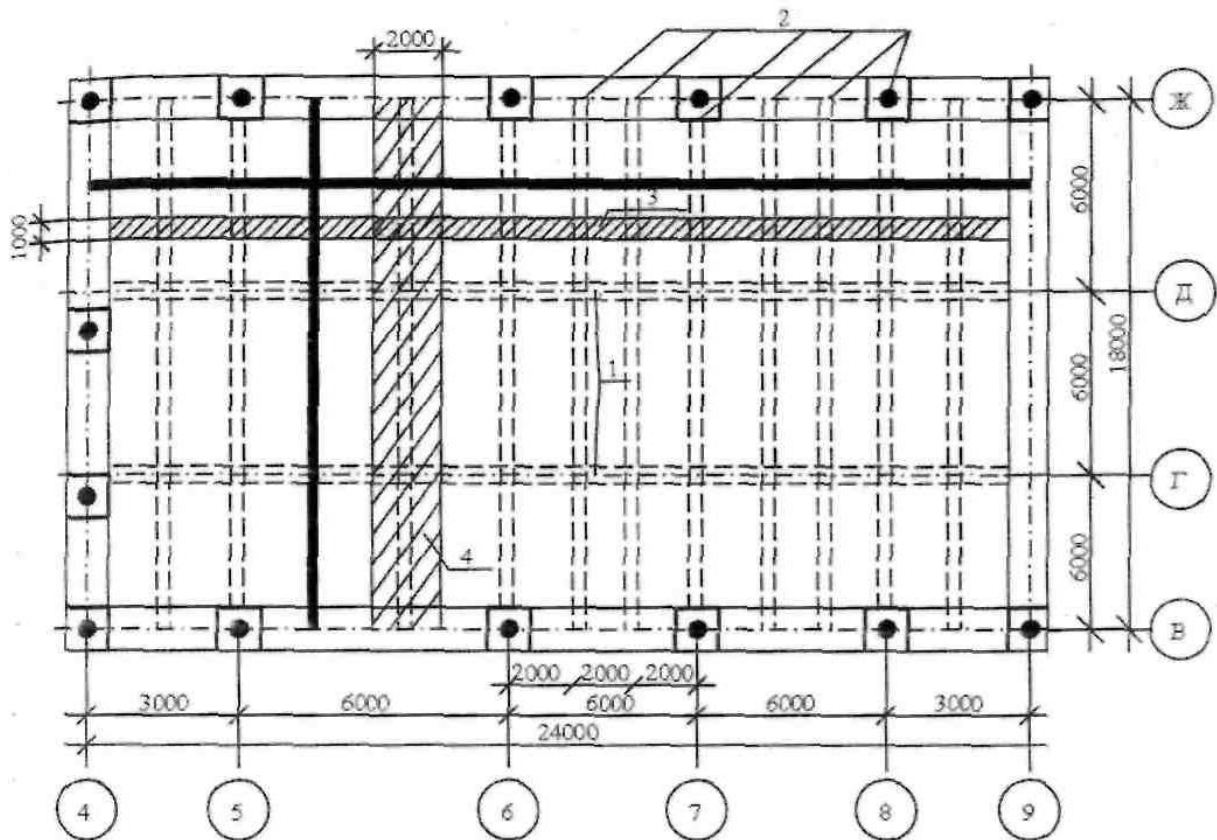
Конструктивна схема монолітного ребристого покриття: 1 - головні балки; 2 - другорядні балки; 3 - розрахункова площа плити; 4 - вантажна площа другорядної балки.
